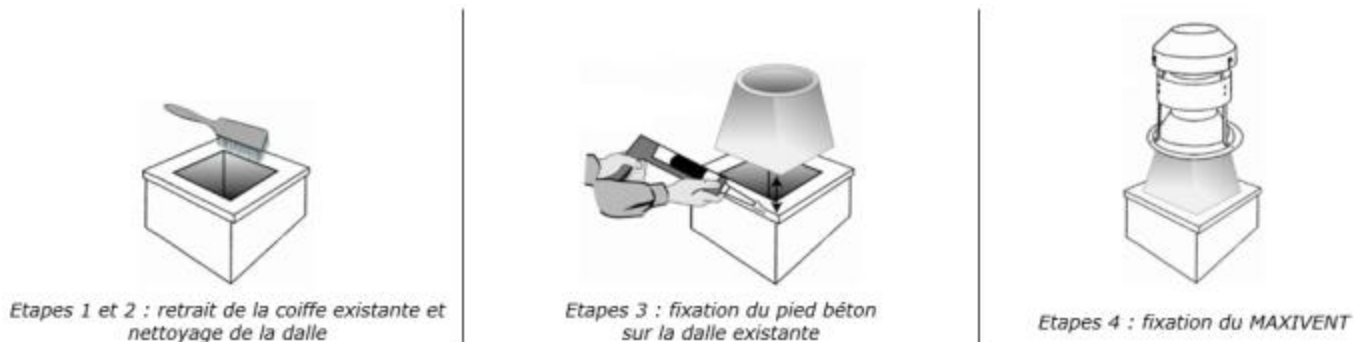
Mise en œuvre de l'extracteur en cas de conservation de la dalle existante
